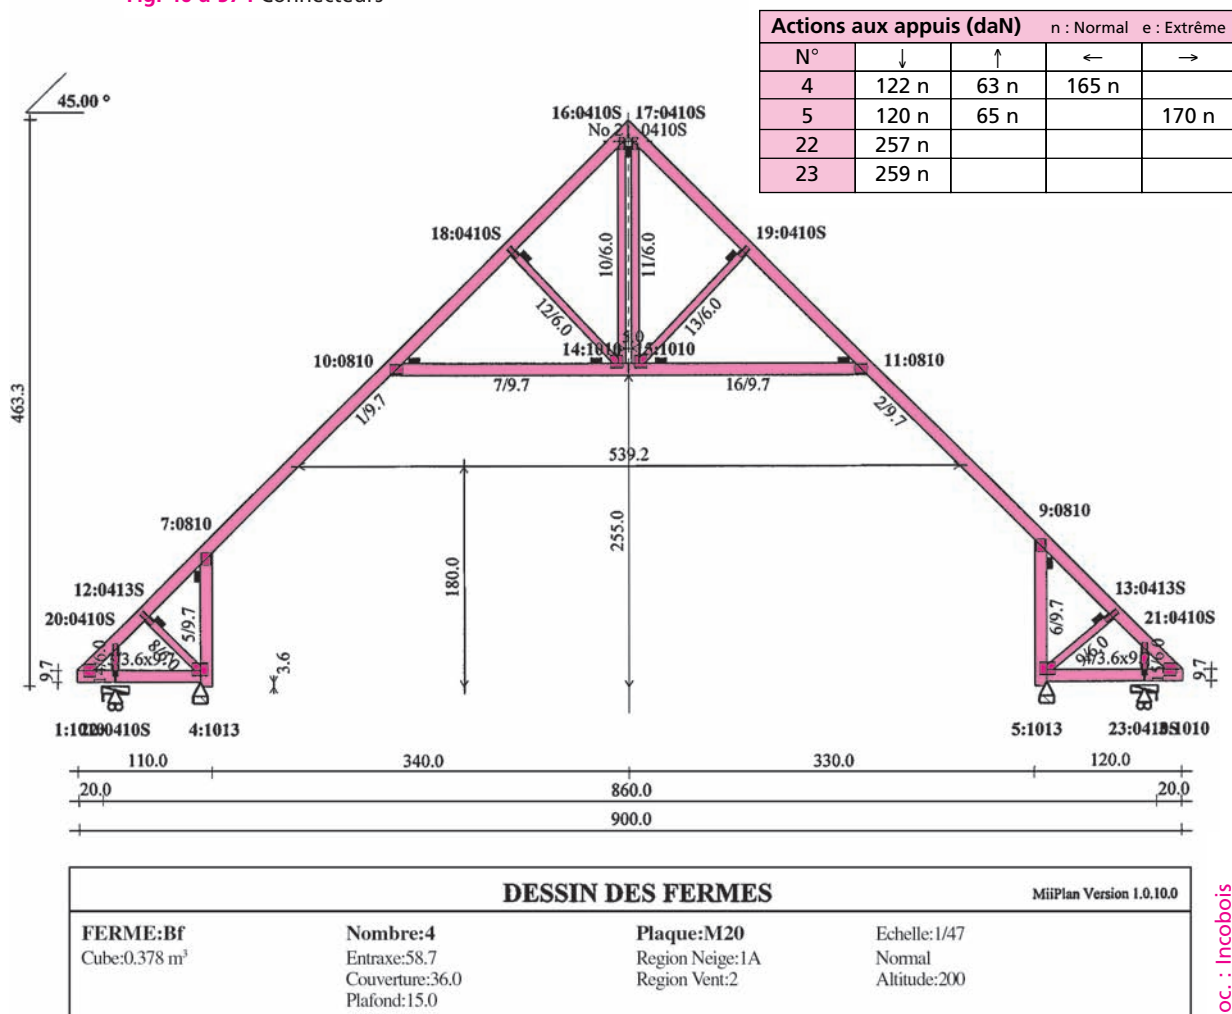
Élévation d'une ferme avec repérage des connecteurs et les types d'appui sur le plancher
